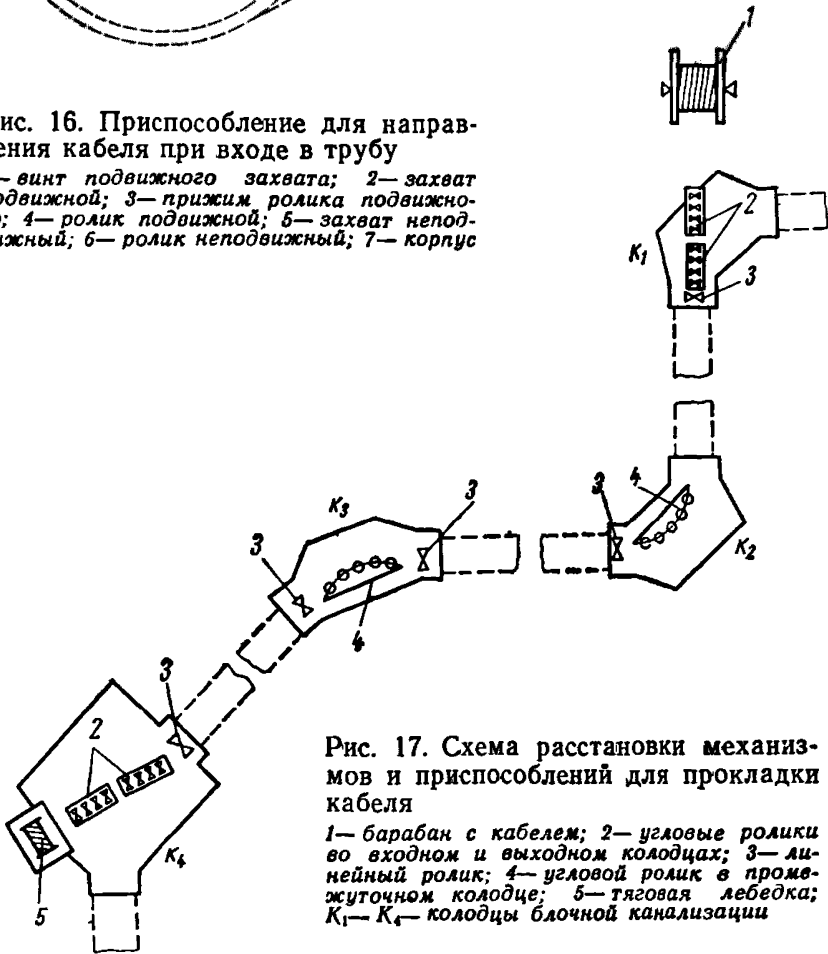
Схема расстановки механизмов и приспособлений для прокладки кабеля
